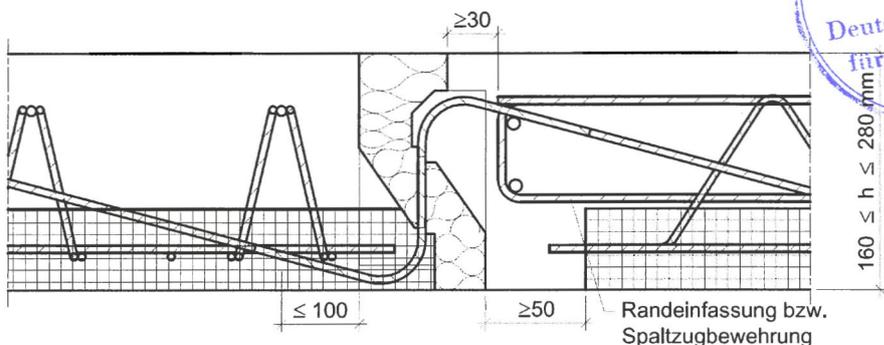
Beispiel Schöck Isokorb Typ V mit Elementplatten
